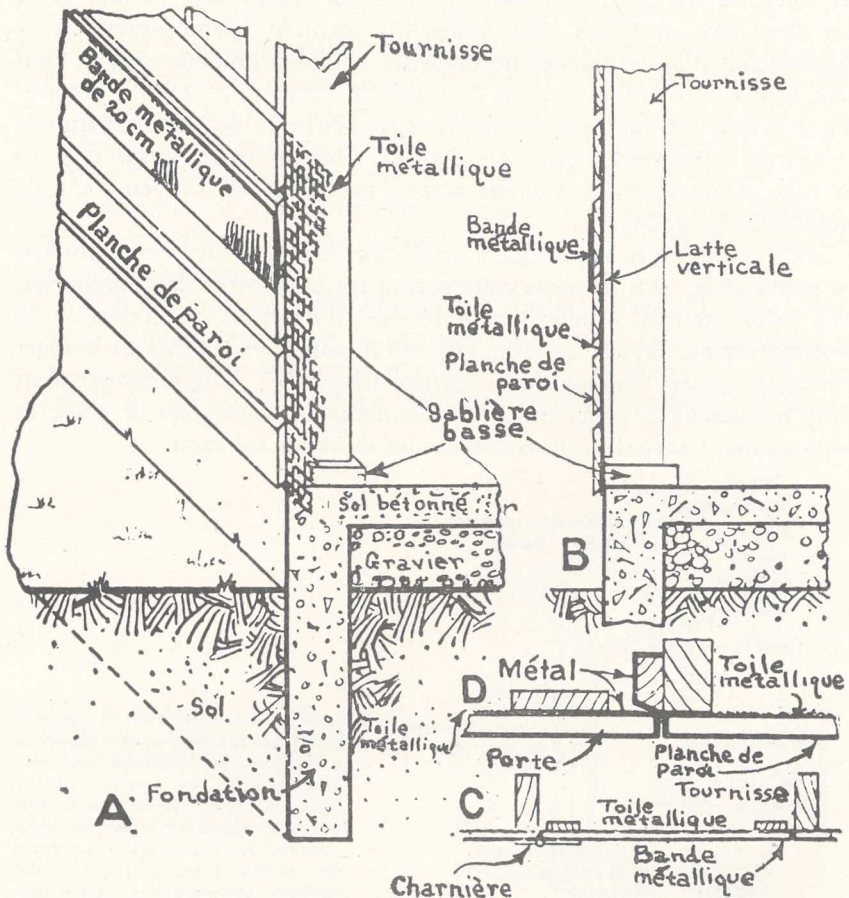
Suggestion pour la construction d'une grange à maïs américaine: A, coupe du mur; B, coupe de la porte, qui est faite de planches clouées sur des montants; la bande de métal sur le mur se prolonge en travers de la porte, mais est coupée et recourbée à l'intérieur des bords de la porte. C, coupe de la porte; D, détail du chambranle du côté où la porte se ferme.
